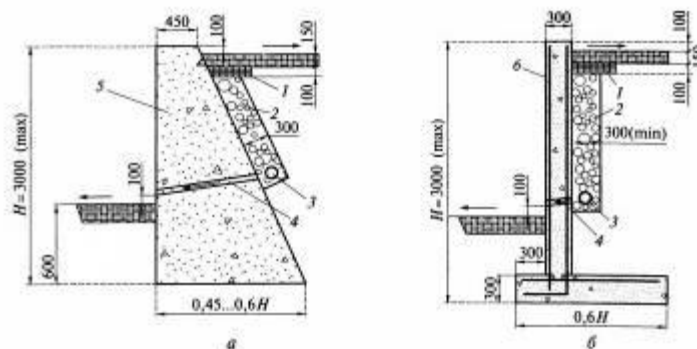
Основні елементи конструкції підпірної стінки : 1 - водовідведення; 2 - дренаж; 3 - фундамент; 4 - тіло
